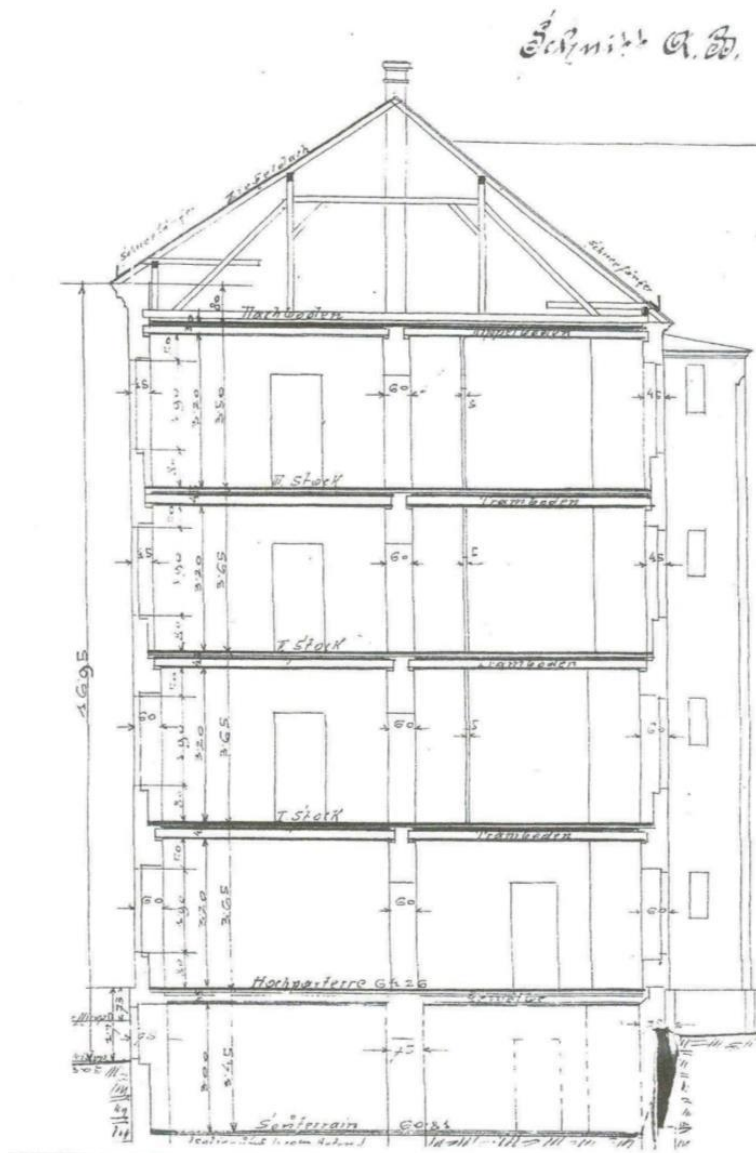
Plan eines Gründerzeithauses mit Tram- und Dippelbaumdecken und Dachwerk aus Holz (Quelle: Architekt Reinberg)
